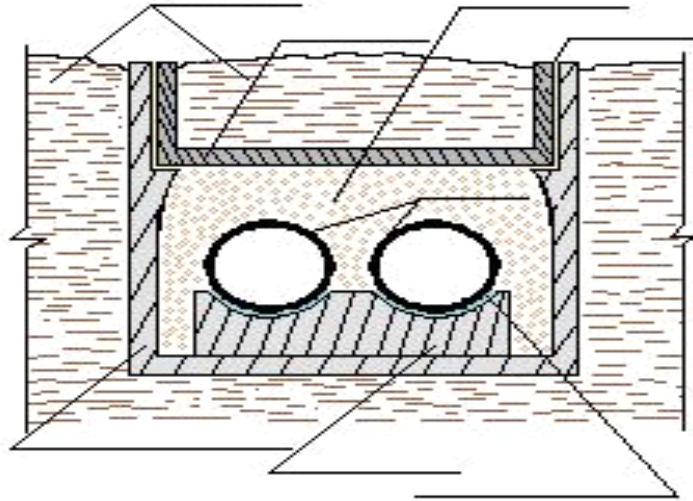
Прокладка подземных трубопроводов в поперечном разрезе
